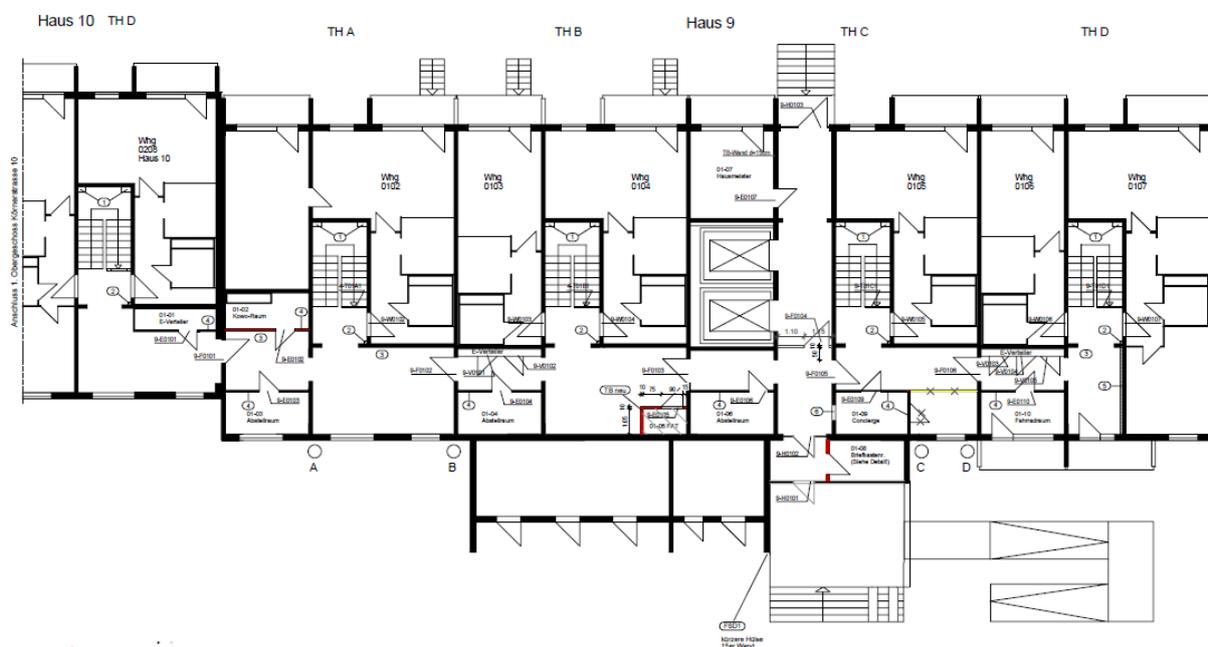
Grundriss Bestand Erdgeschoss, Körnerstraße 9
